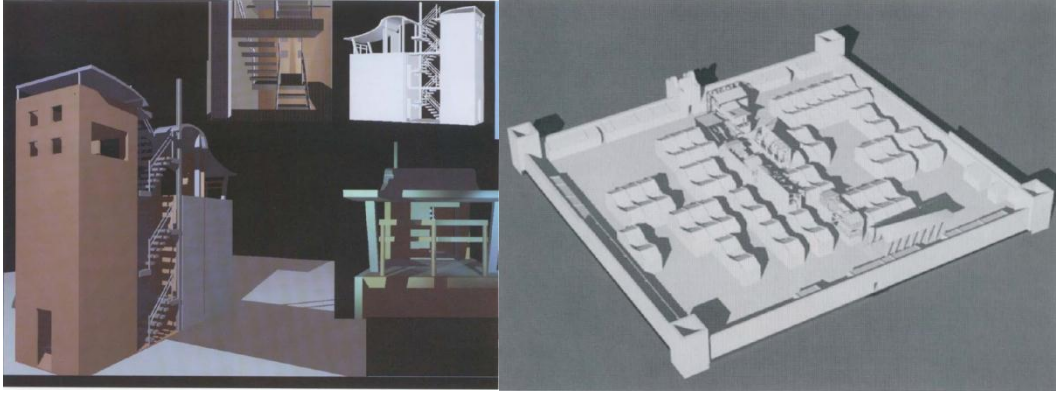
Kat Hing Wai köyüne ait plan (Wojtowicz, 1995)
